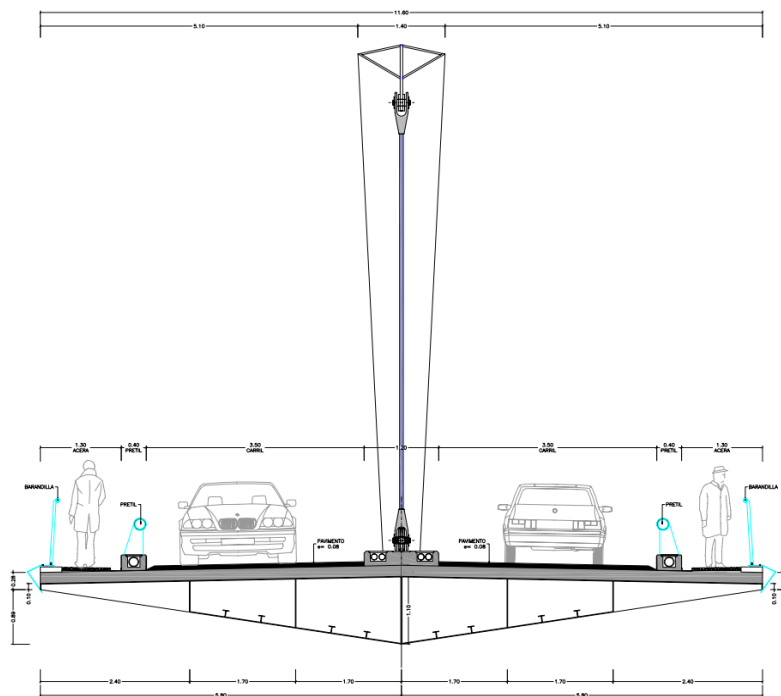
Sección transversal del tablero en el Centro Luz (Proyecto del puente)
